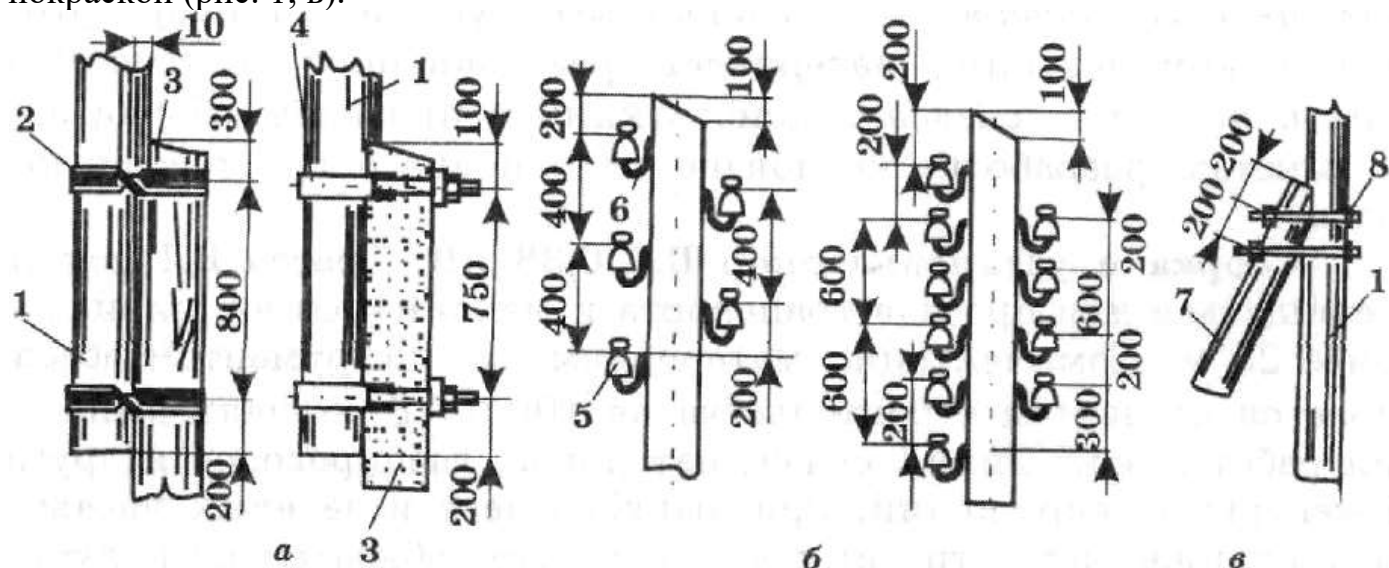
Технология сборки деревянных опор: а — крепление деревянной и железобетонной приставок к стойке; б — установка крюков с изоляторами для одинарного и двойного крепления проводов; в — крепление подкоса к опоре: 1 — стойка; 2 — бандаж; 3 — приставка; 4 — хомут; 5 — изоляторы; 6 — крюк; 7 — подкос; 8 - болт
